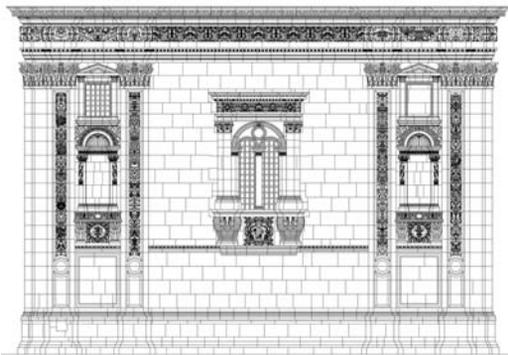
Levantamiento de planimetría Fachada Este. Informe sobre la intervención en el primer cuerpo de la torre de la catedral de Murcia realizado para la documentación de patologías detectadas y tratamientos aplicados. 2010. Artelan Restauración S.L.
